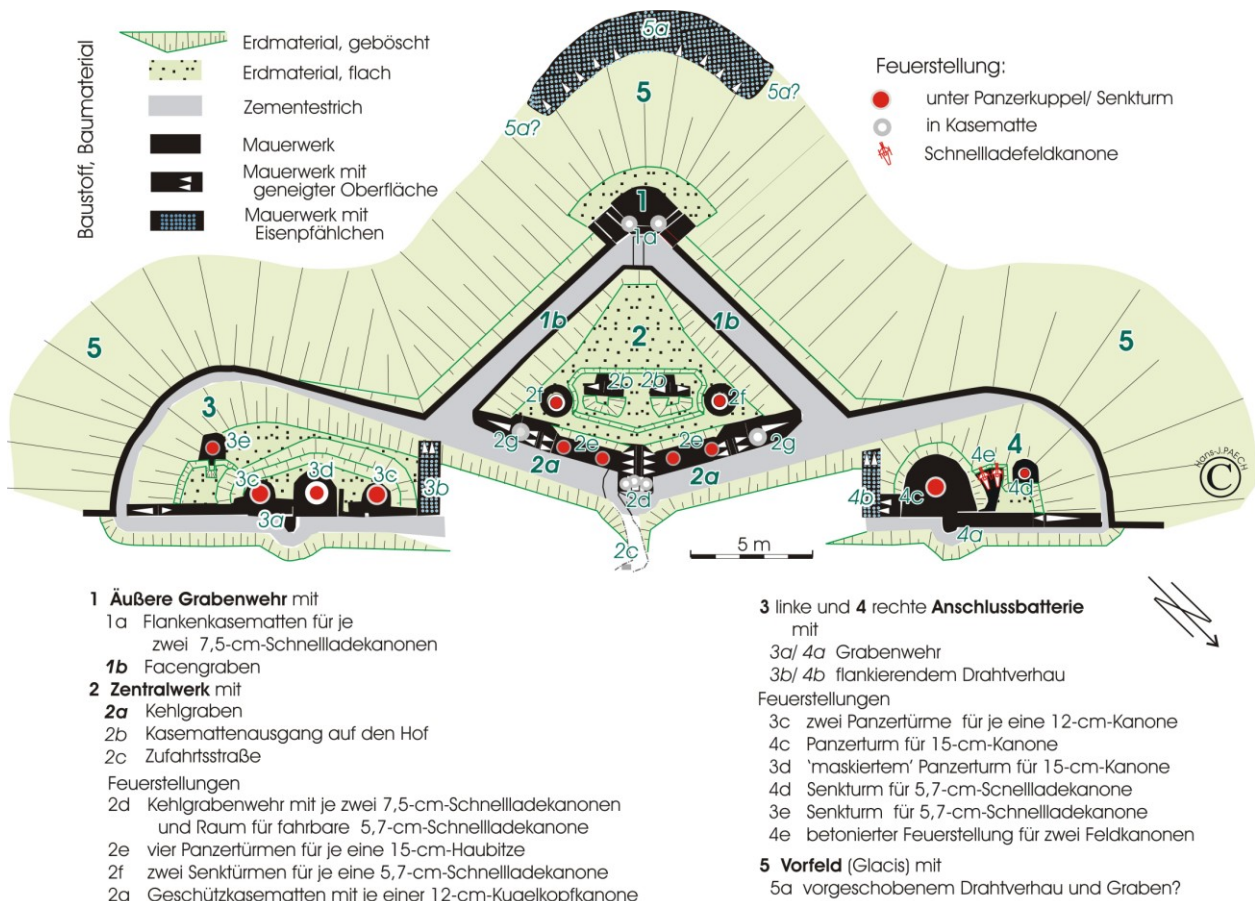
Neuester Grundriss des Modell-Forts
